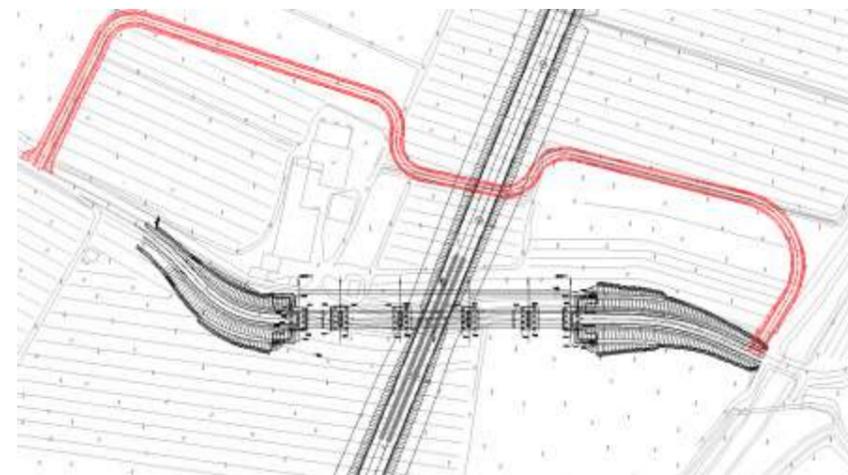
Stralcio planimetrico tipo: Viabilità provvisoria
